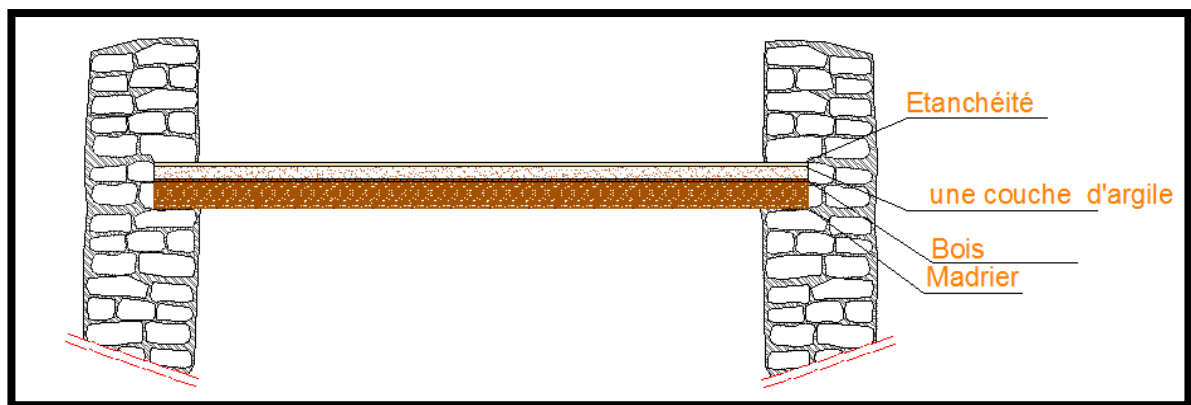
coupe d'un plancher traditionnelle Source : Auteur
